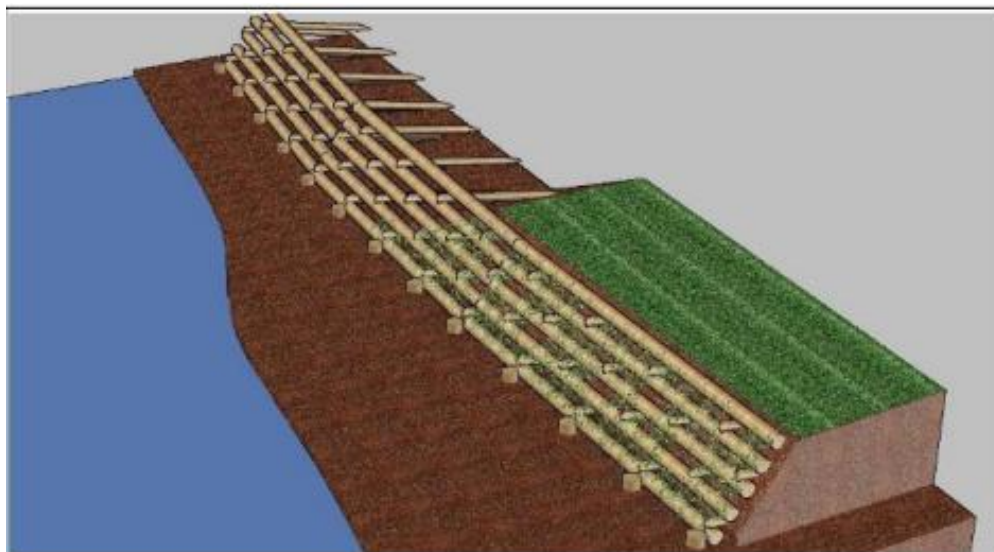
Vista tridimensional da construção da parede de Krainer.
